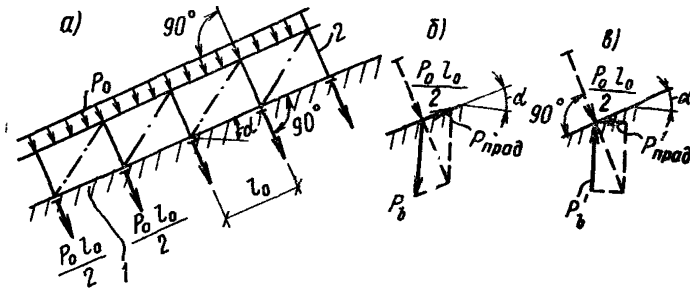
Передача нагрузки от веса ленты с грузом через станину транспортера на конструкции галерей
